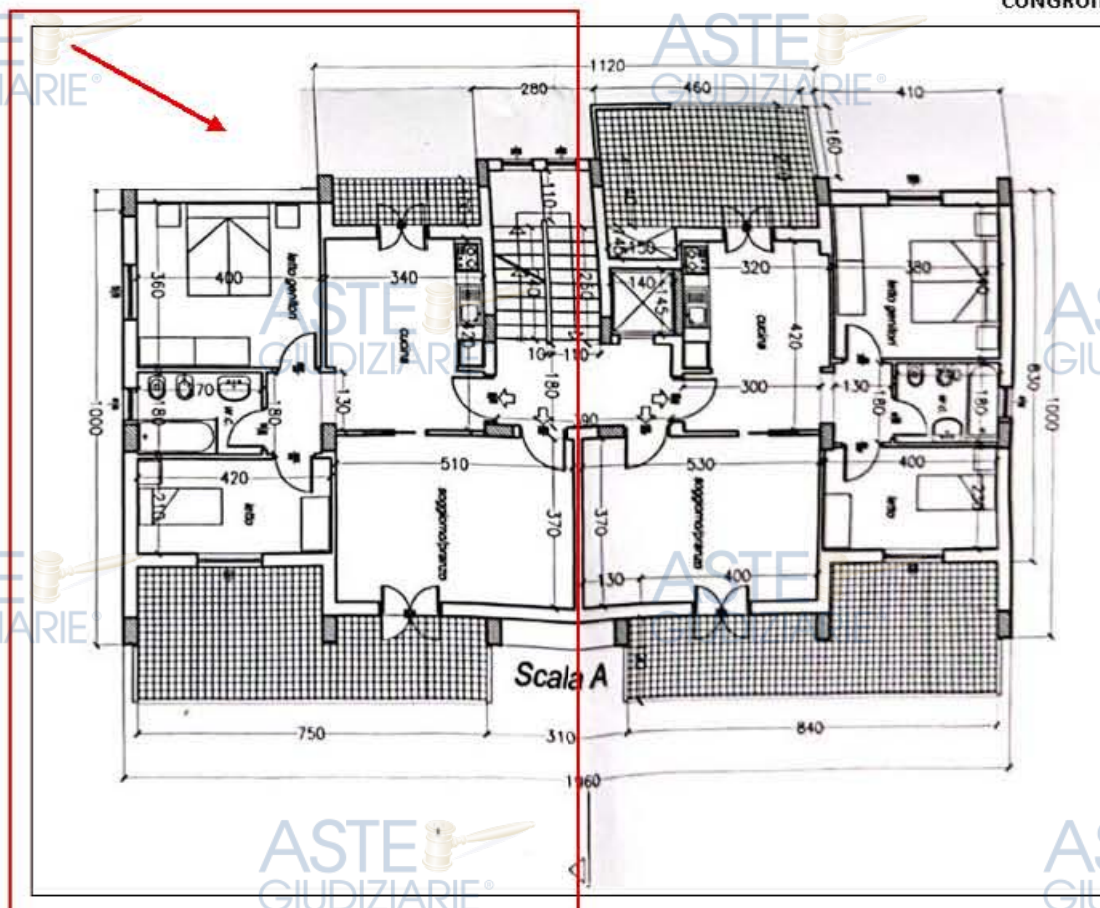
Planimetrie scala A piano secondo progetto di variante
